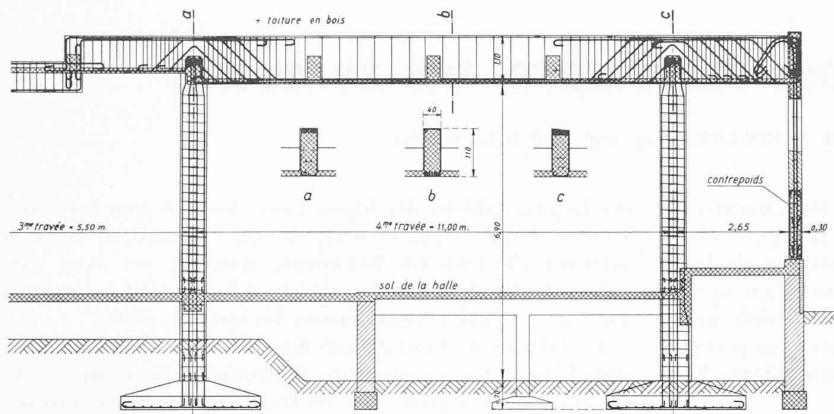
Détail d'armature des poutres du plafond de la halle des porcs avec sommiers formant contrepoids. — Echelle 1 : 160.
